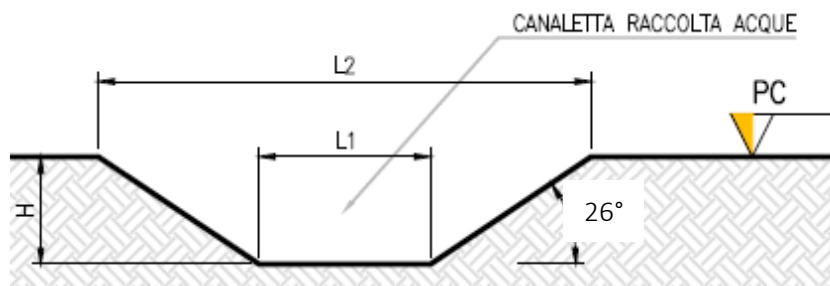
Sezione tipologica canaletta di drenaggio realizzata in scavo.
